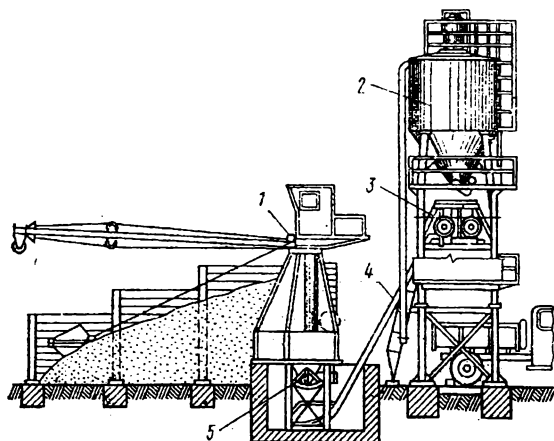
Схема инвентарной бетоносмесительной установки:
